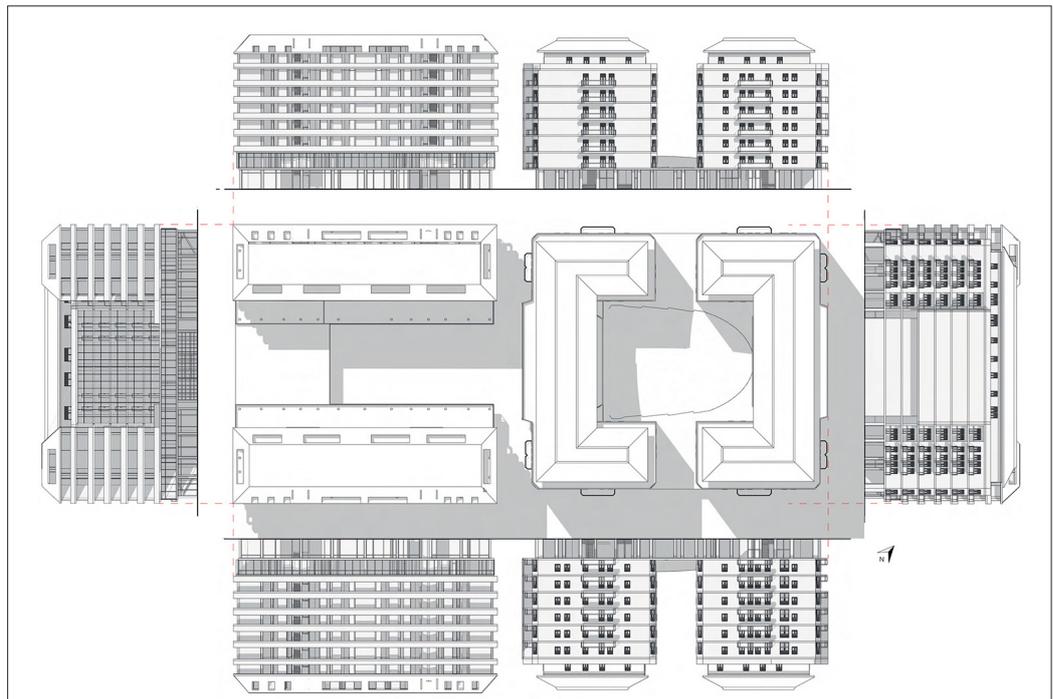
Planivolumetrico e prospetti dello stato di fatto.
